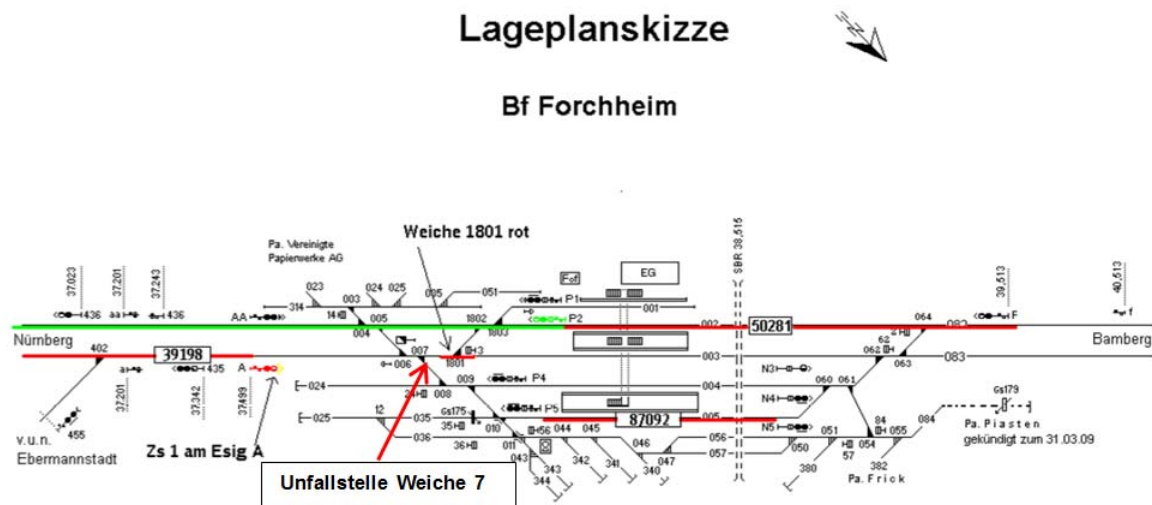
Lageplanskizze mit beteiligten Zugfahrten
